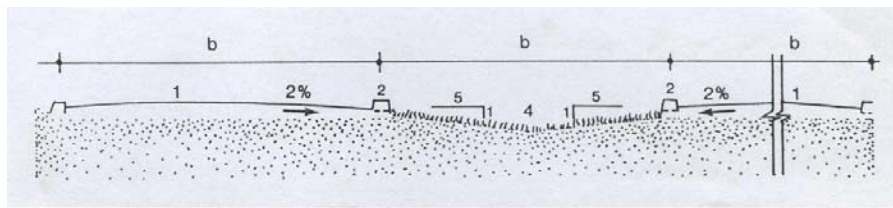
Perfil en calles con bandejones. 1.- Calzada impermeable, 2.- Solera discontinua, 3.- Superficie permeable, 4.- Zanja con vegetación.
